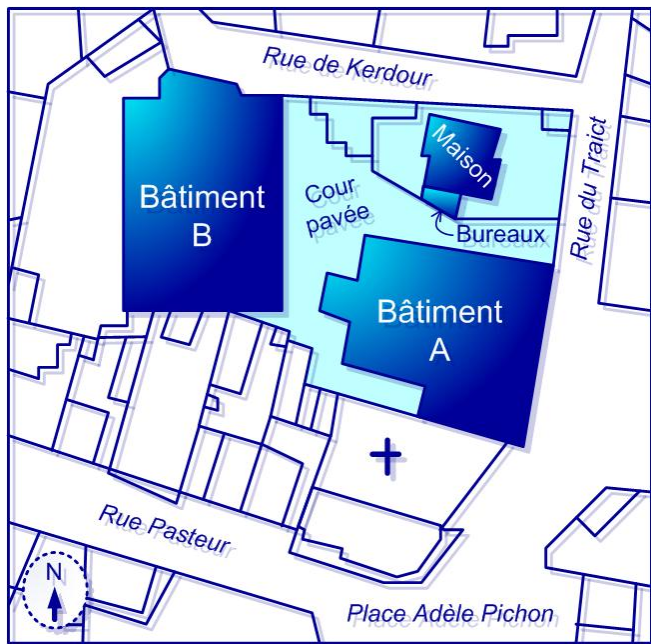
PLAN D'IMPLANTATION CADASTRAL DE LA PROPRIETE BERTRAND, BATZ-SUR-MER
